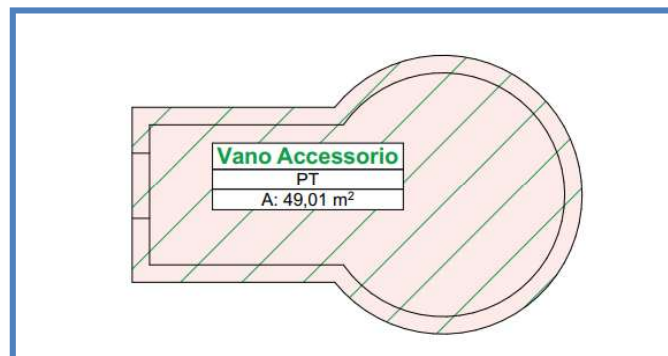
fabbricato sorgente - PIANTA PIANO TERRA
